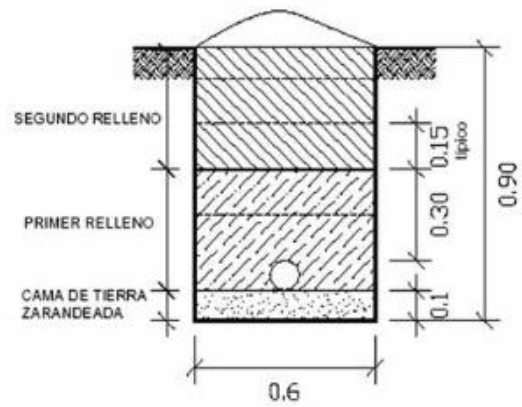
Sección transversal de una zanja para instalación de tubería.
